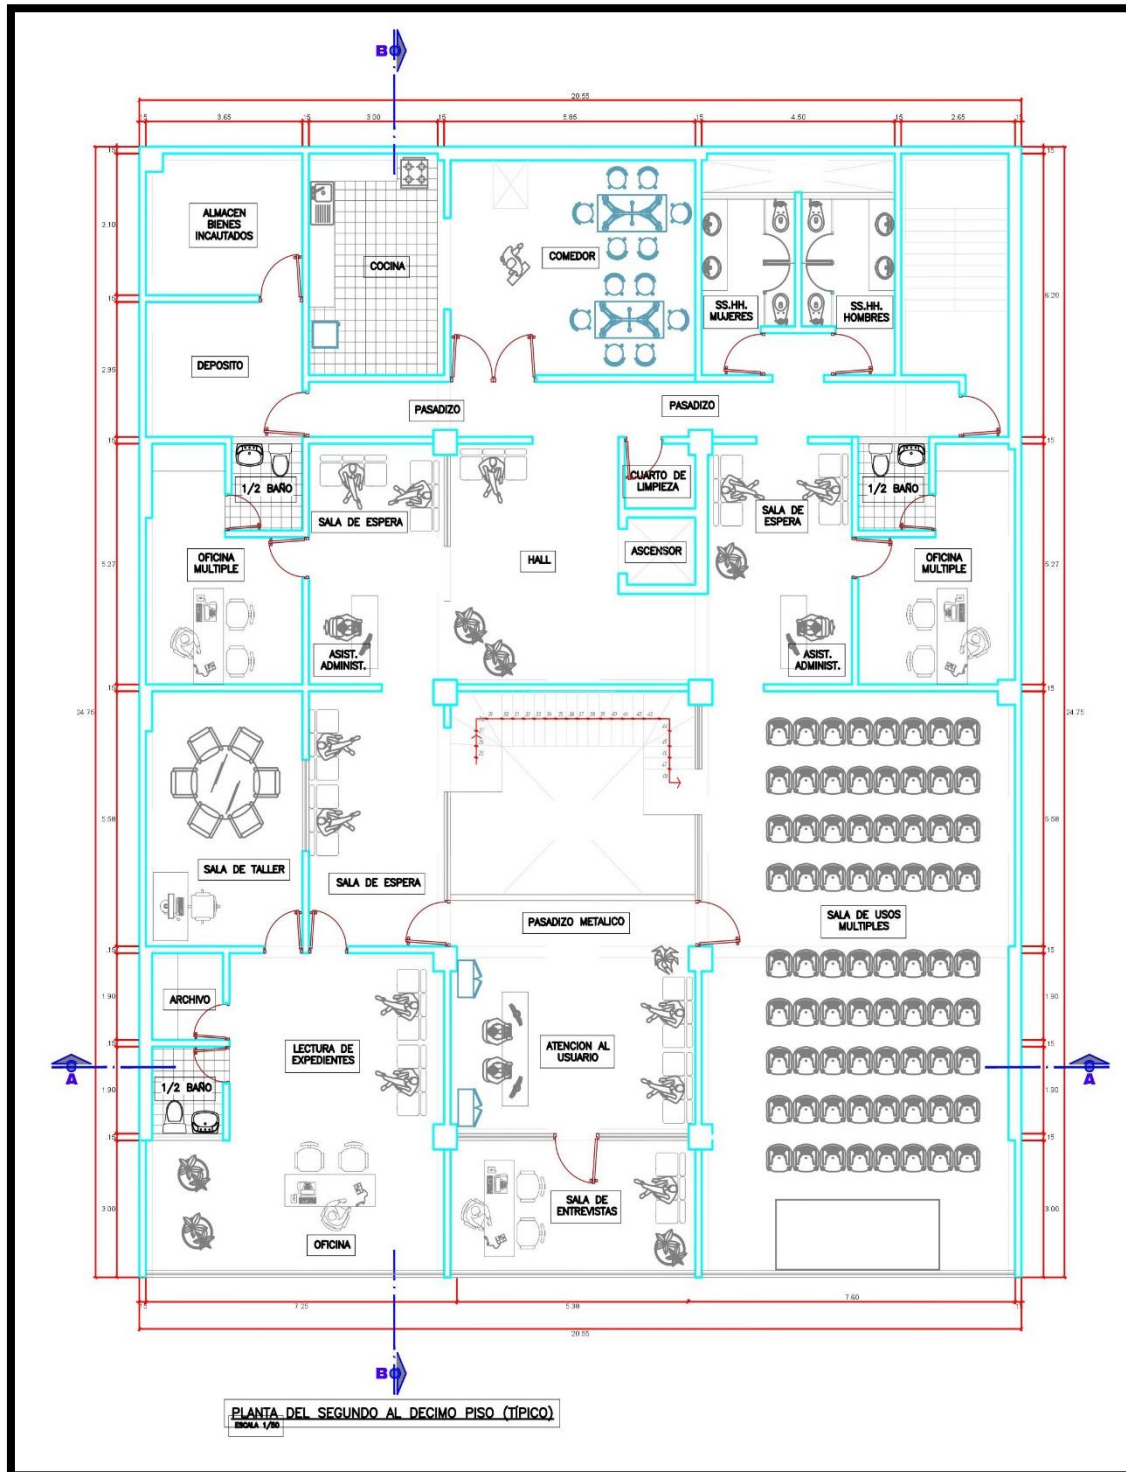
Plano en planta de la arquitectura del segundo nivel al décimo.
